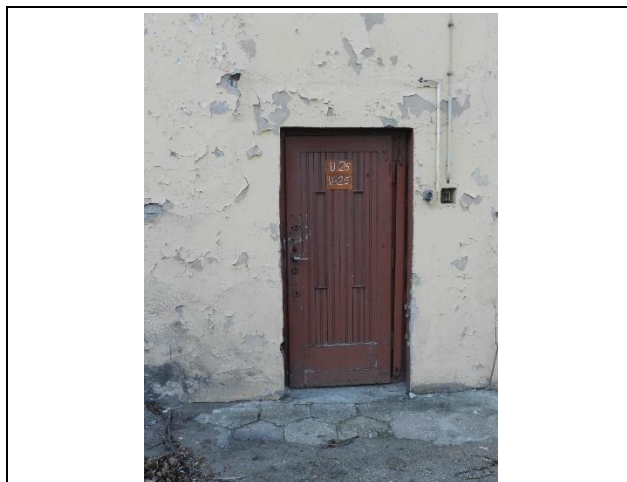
Widok ogólny budynku – elewacja i wschodnia
